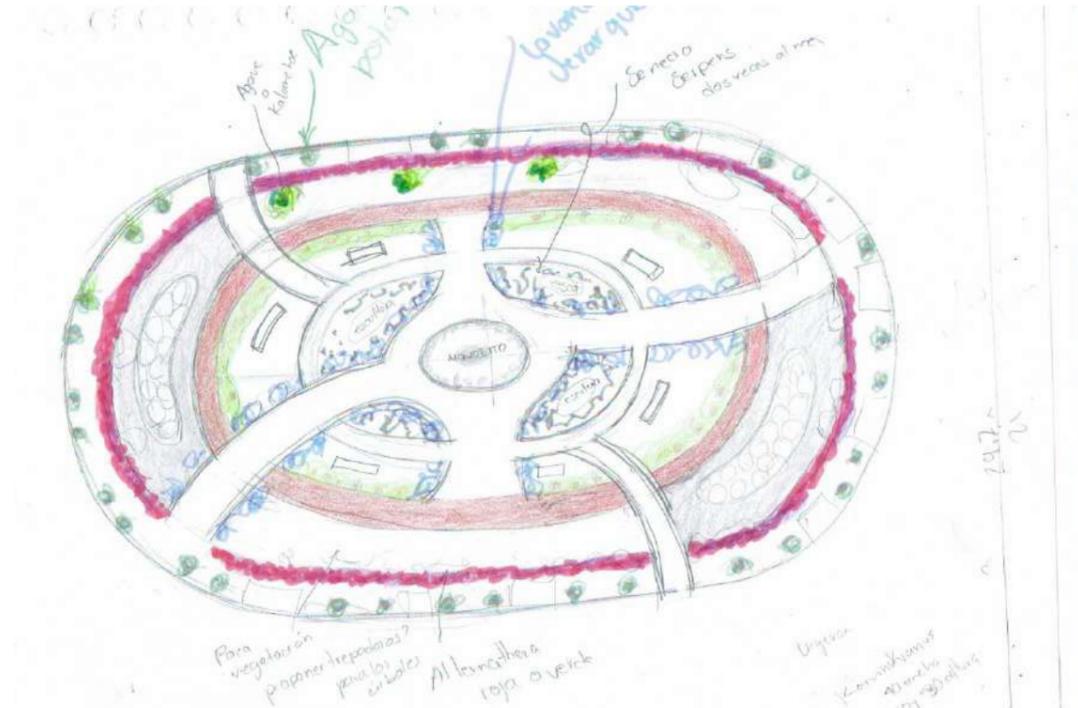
Croquis propuesta Glorieta, Romero M, 2020
